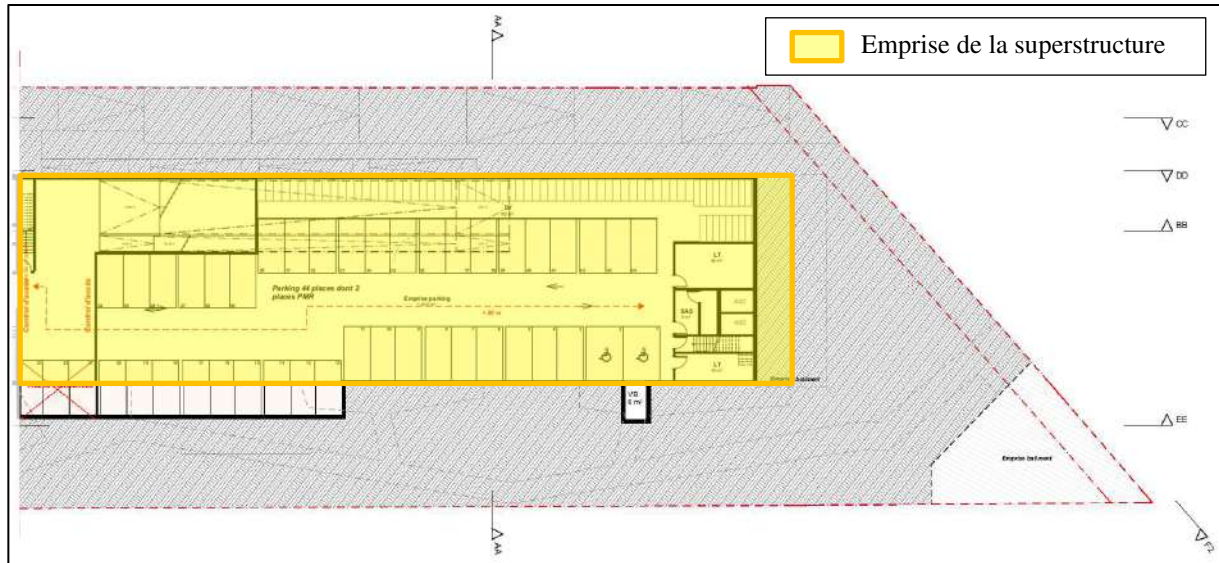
Plan du sous-sol du projet – lot 2 (BRENAC & GONZALEZ Architectes)
